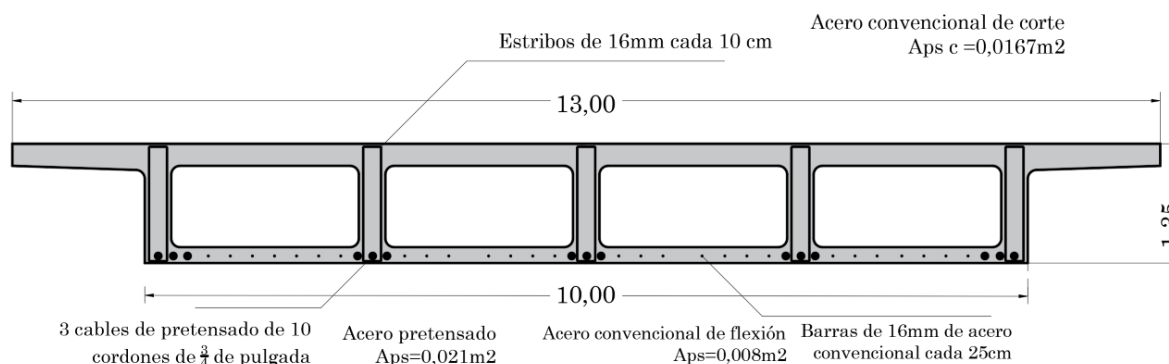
Esquema de sección transversal de viga con armaduras de acero verificada (Fuente: Elaboración propia).
